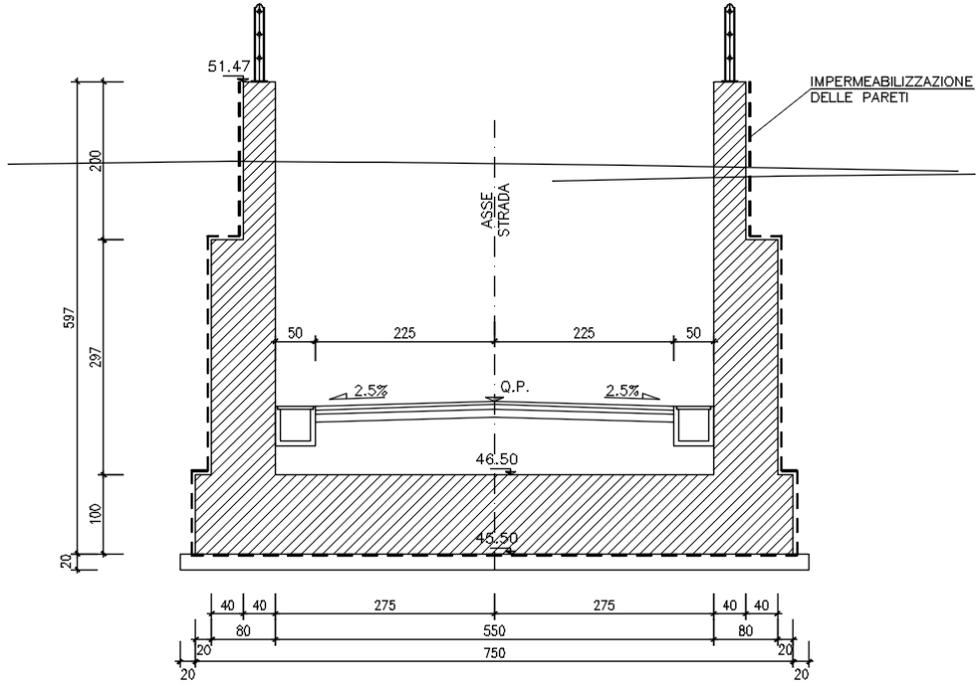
Sezione 1 di calcolo muri di imbocco SL13
